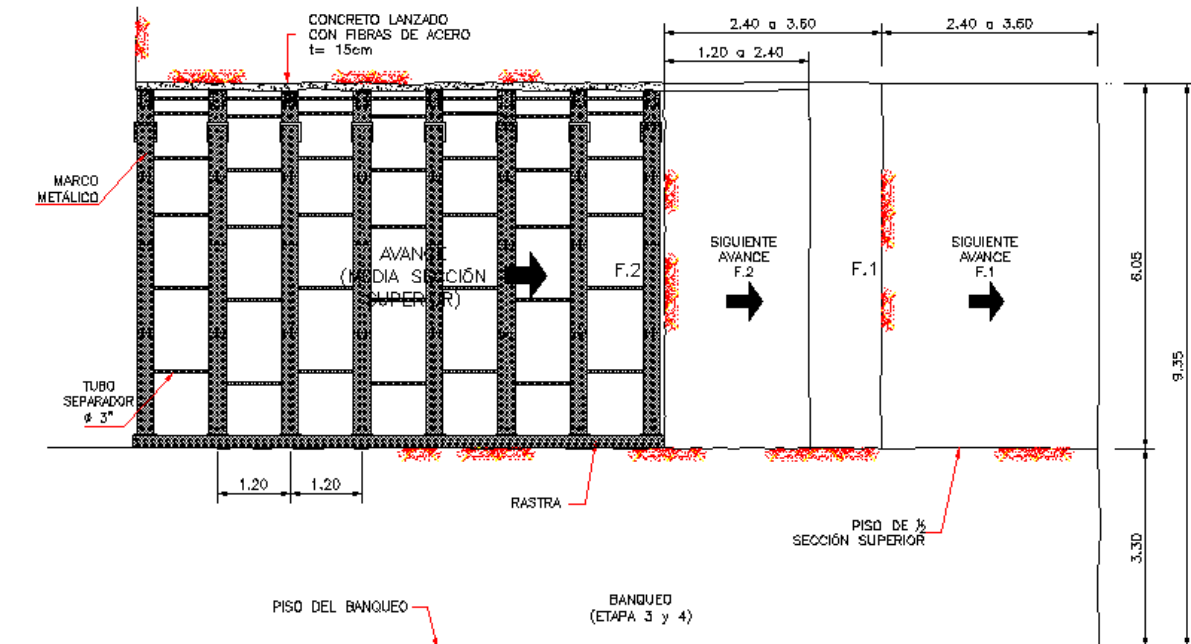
Perfil del túnel donde se indican las fases de excavación.
